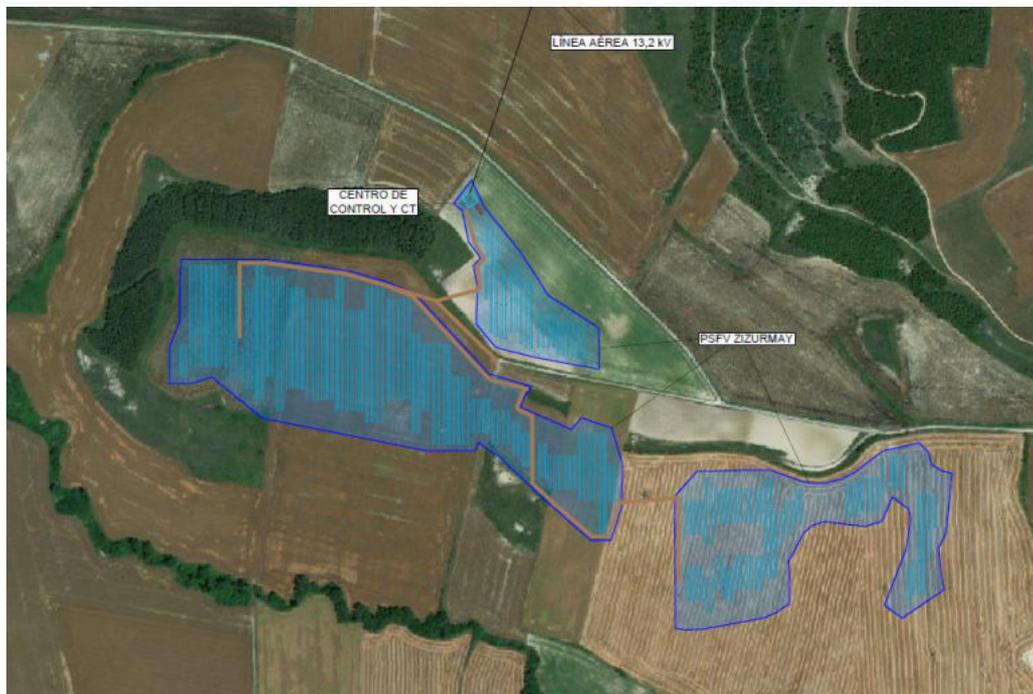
Layout de la planta planta PSFV Zizurmay.
